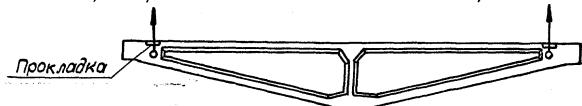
Схема строповки балки при подъеме в вертикальном положении (при установке на колонны)
